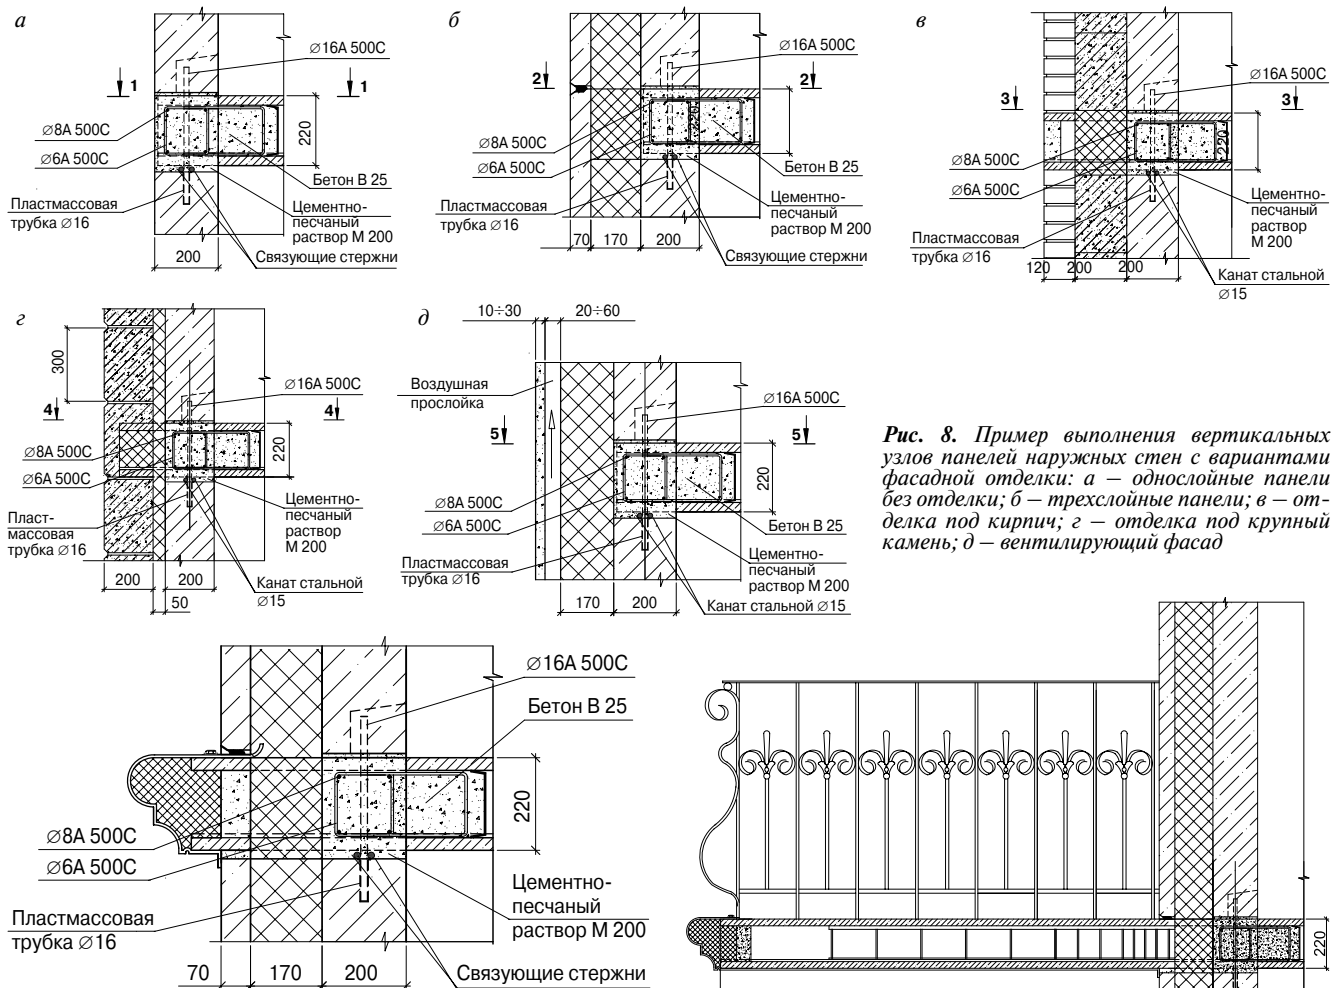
Пример выполнения вертикальных узлов панелей наружных стен с вариантами фасадной отделки: а – однослойные панели без отделки; б – трехслойные панели; в – отделка под кирпич; г – отделка под крупный камень; д – вентилирующий фасад
